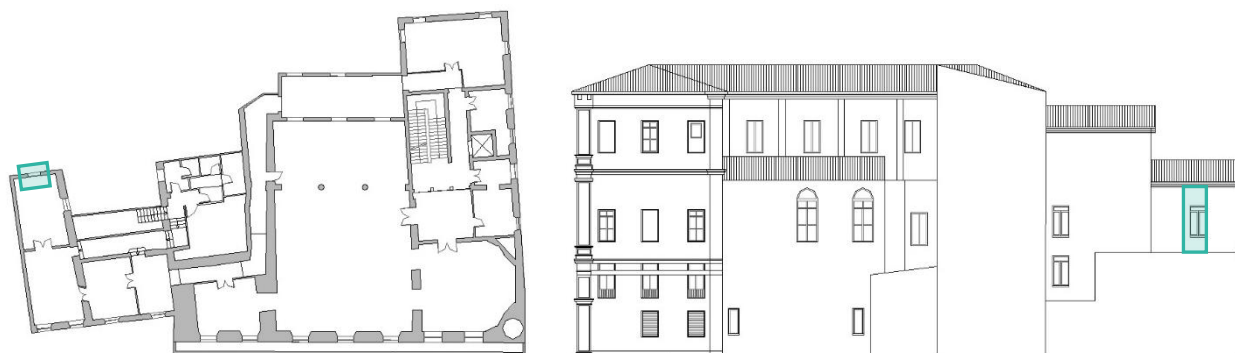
Individuazione macroelemento, pianta e prospetto
